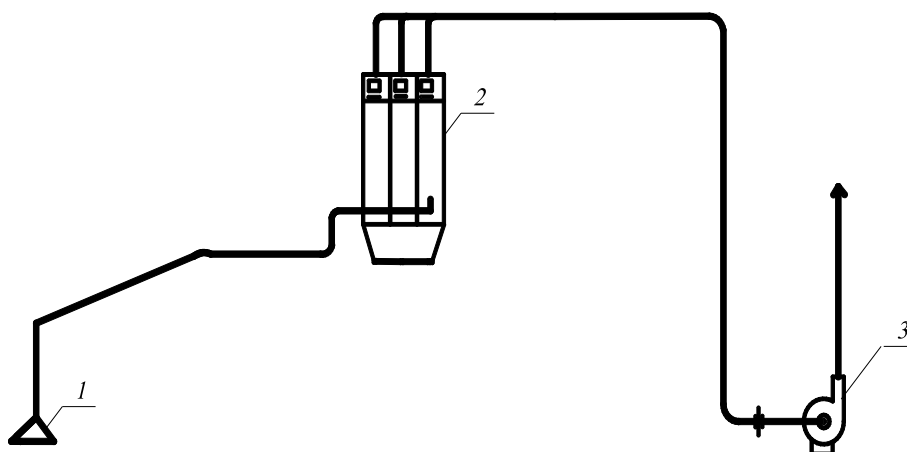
Схема системы обеспыливания цеха упаковки: 1- местный отсос, 2 – рукавный фильтр, 3 - вентилятор
